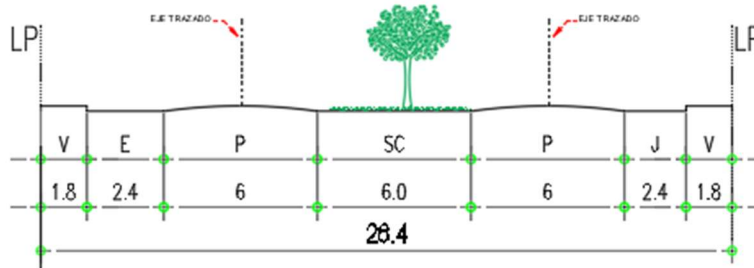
Plano vías y Transporte, ver plano PI - 15
